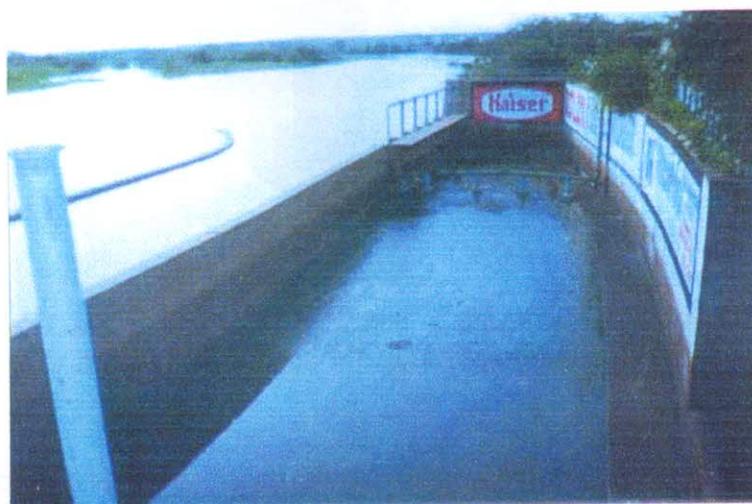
Atual Situação do Canal de Adução do Perímetro de Irrigação de Morada Nova-CE, 2002
